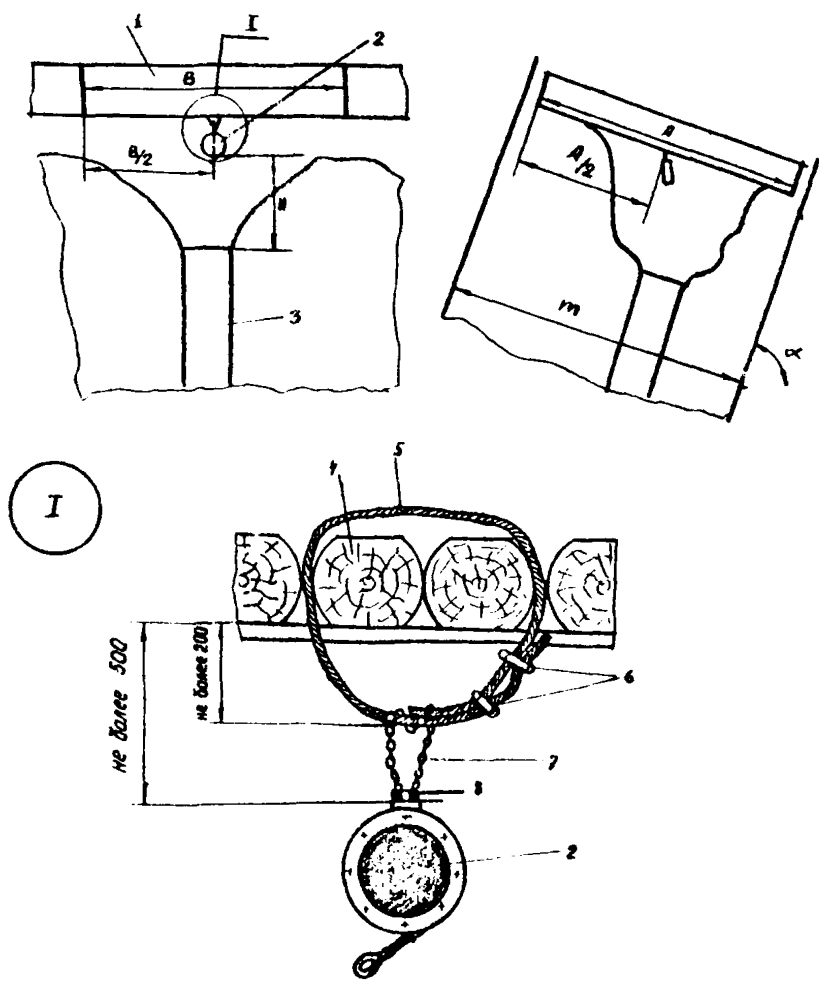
Схема подвески АПУ за щитовое перекрытие:
